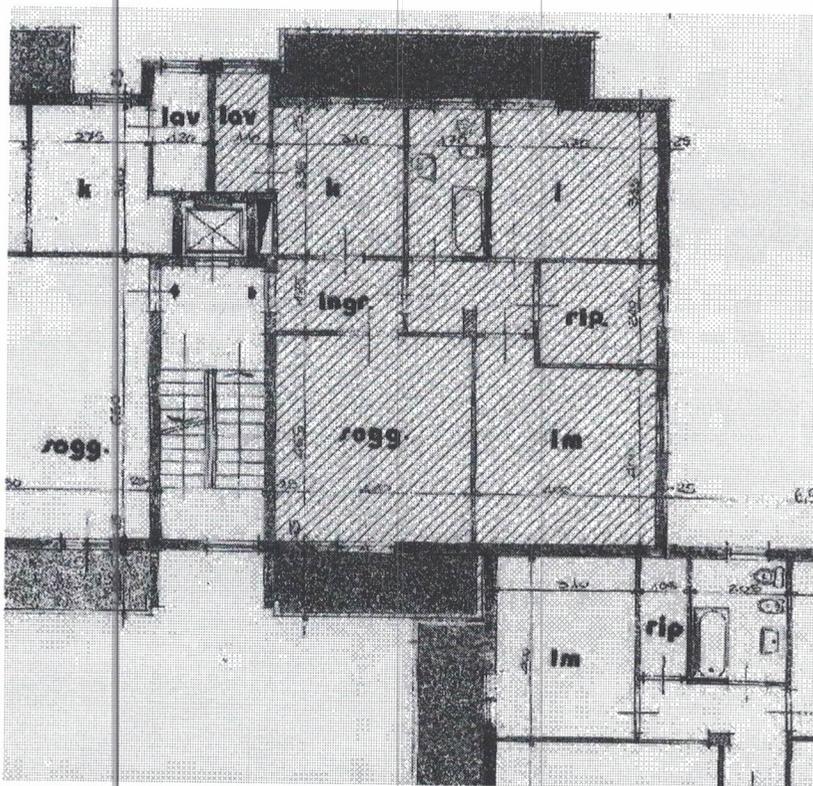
Pianta dell'abitazione (Stralcio elab. grafico allegato all'Autorizzazione Edilizia n. 105/80)
